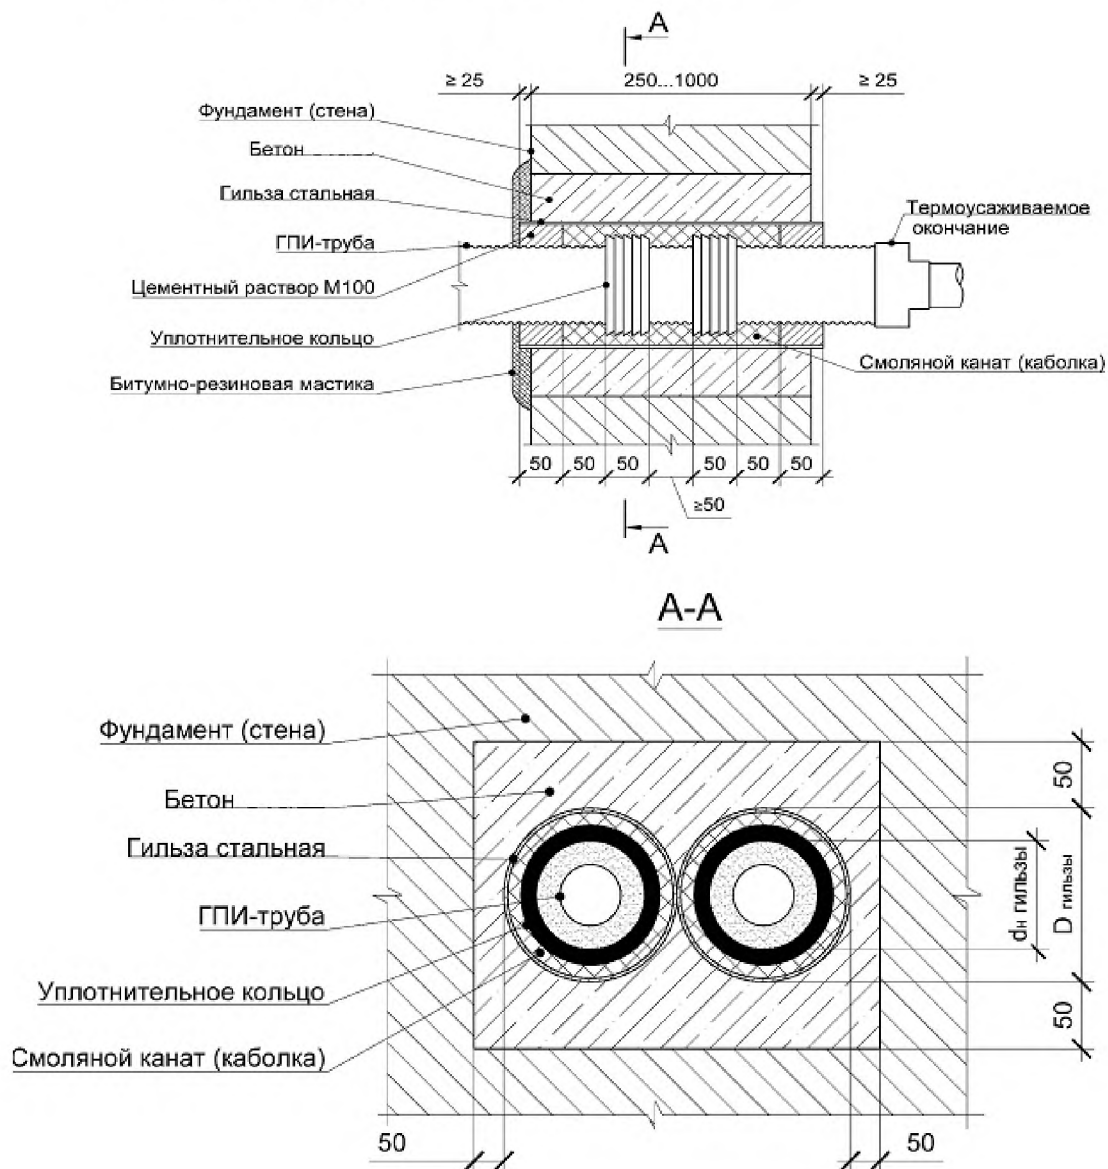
Узел прохода ГПИ-труб через строительные конструкции
